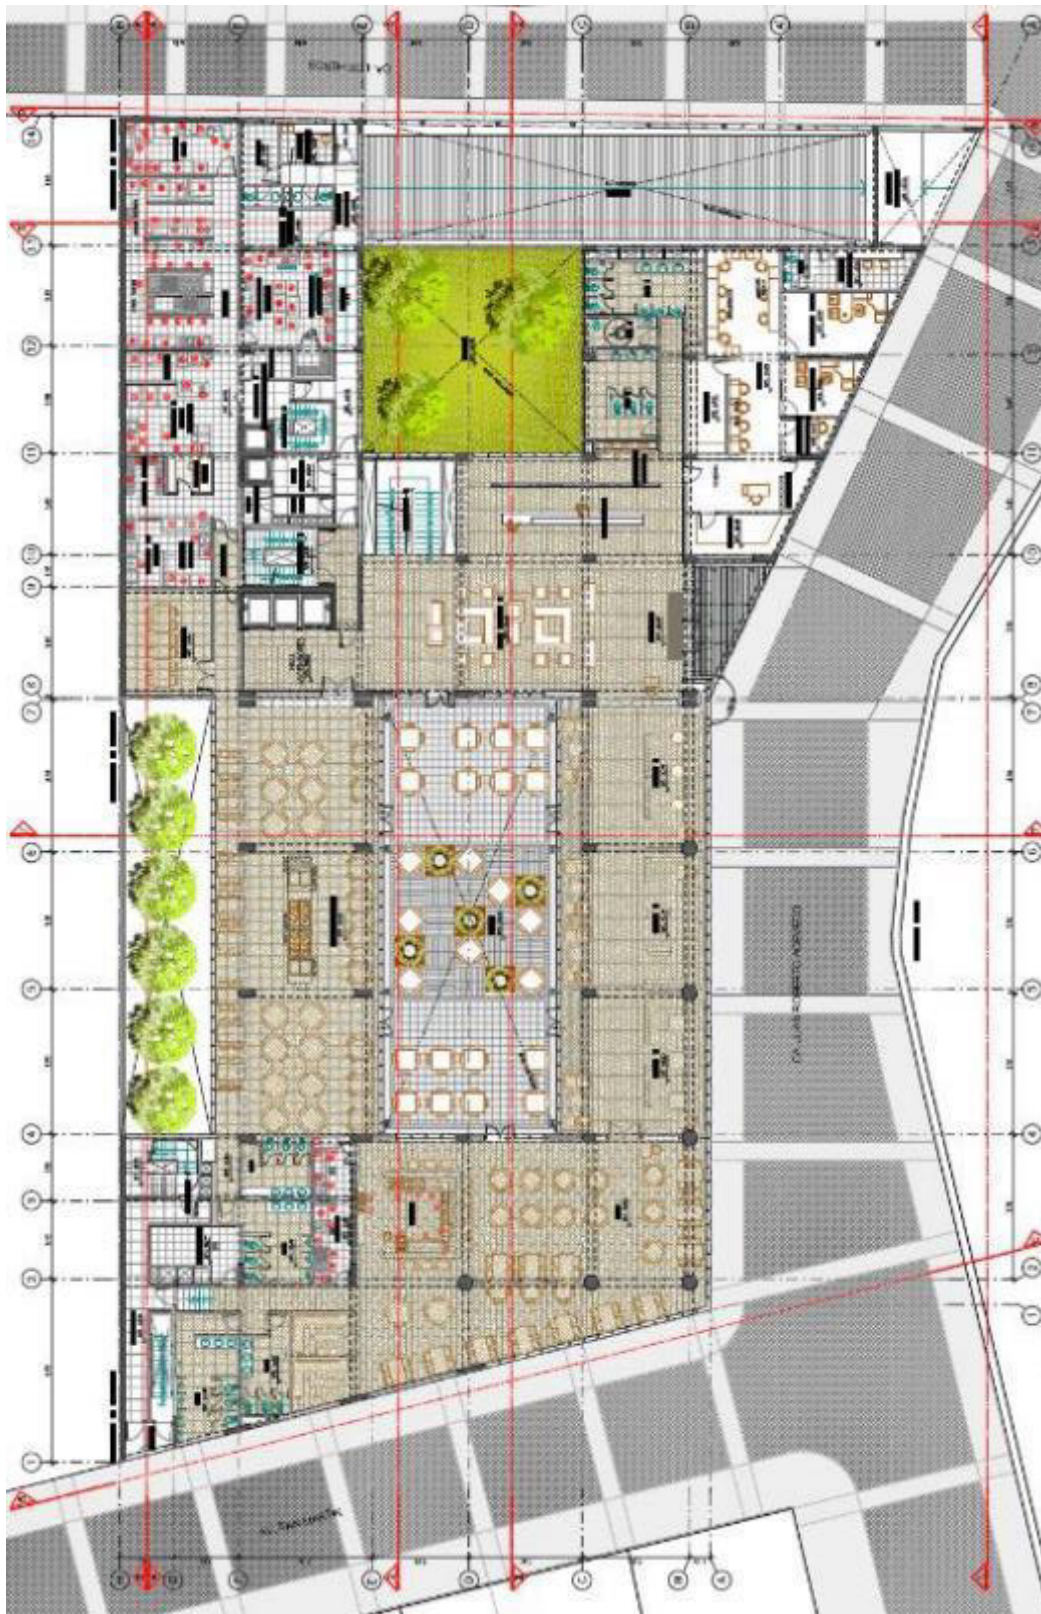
Planta primer sótano del Proyecto.Nota. Elaboración propia.
